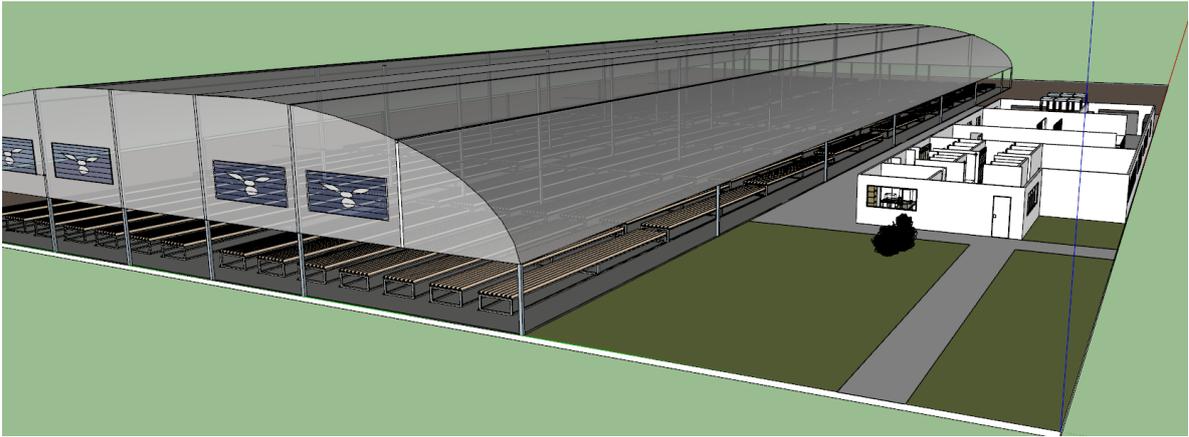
Lay out maduración. Fuente: Elaboración propia
